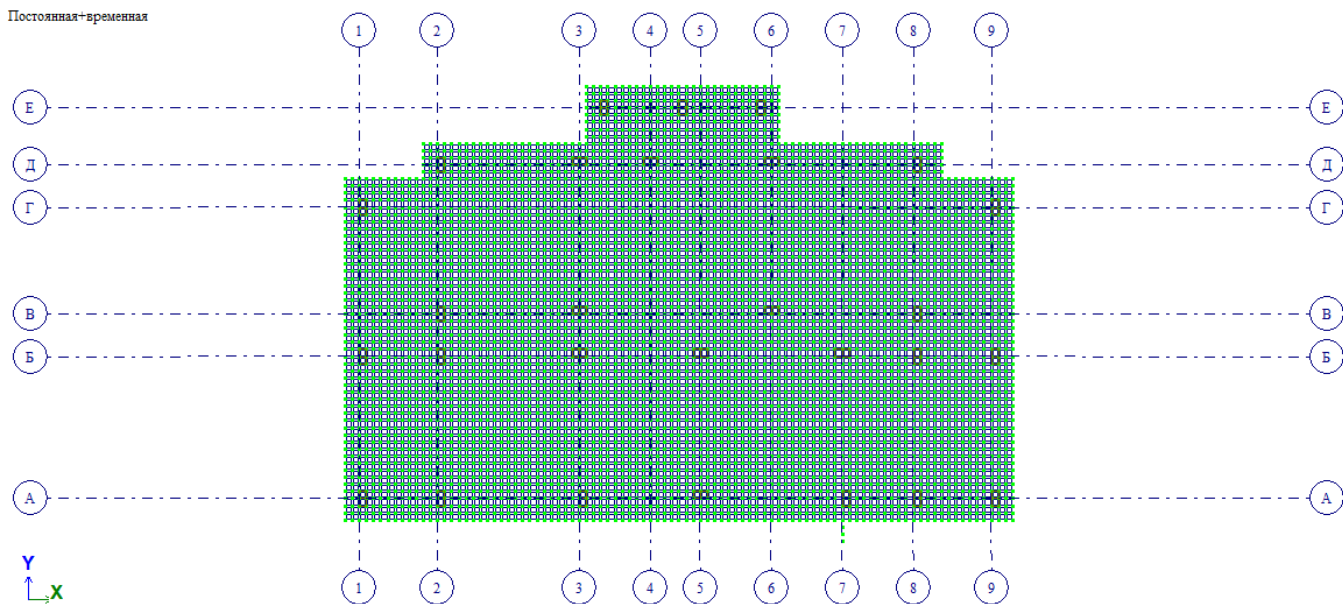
Расчетная схема фундаментной плиты в Лире САПР 2017
